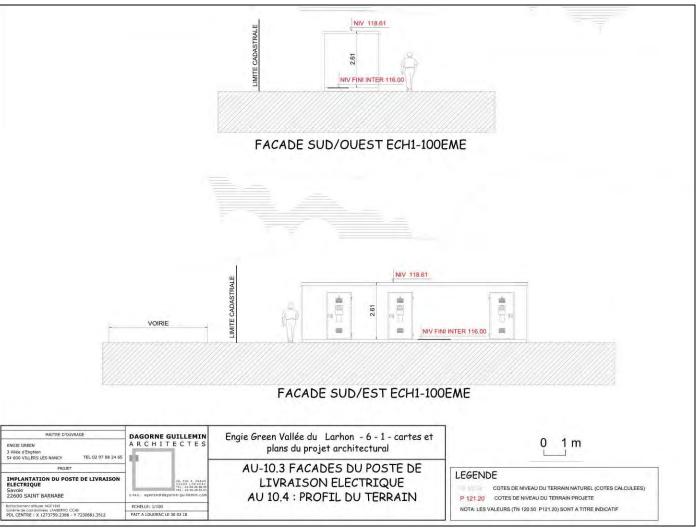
plans des façades sud-ouest et sud-est du poste de livraison
